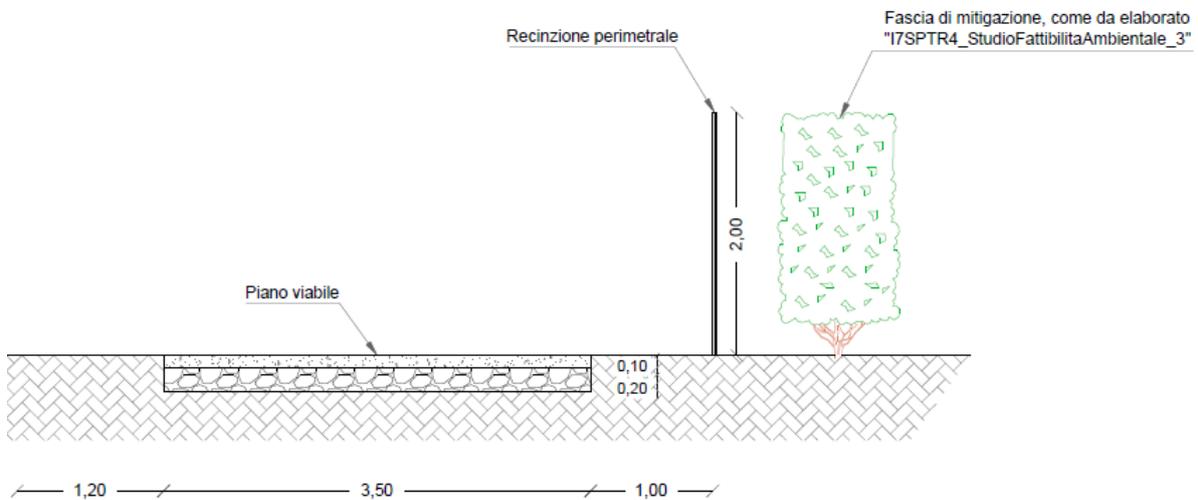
Sezione tipo viabilità interna con siepe esterna alla recinzione
